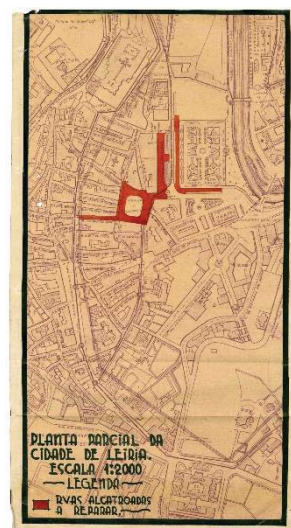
Planta de pormenor com a proposta de pavimentos a renovar elaborada por Ernesto Korrodi. AMLRA 2016.
